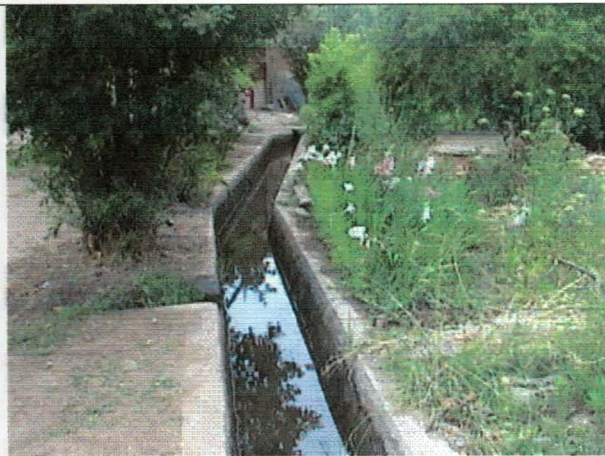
Sección Revestida de Canal La Polcura (Sin Compuerta de Entrega)
